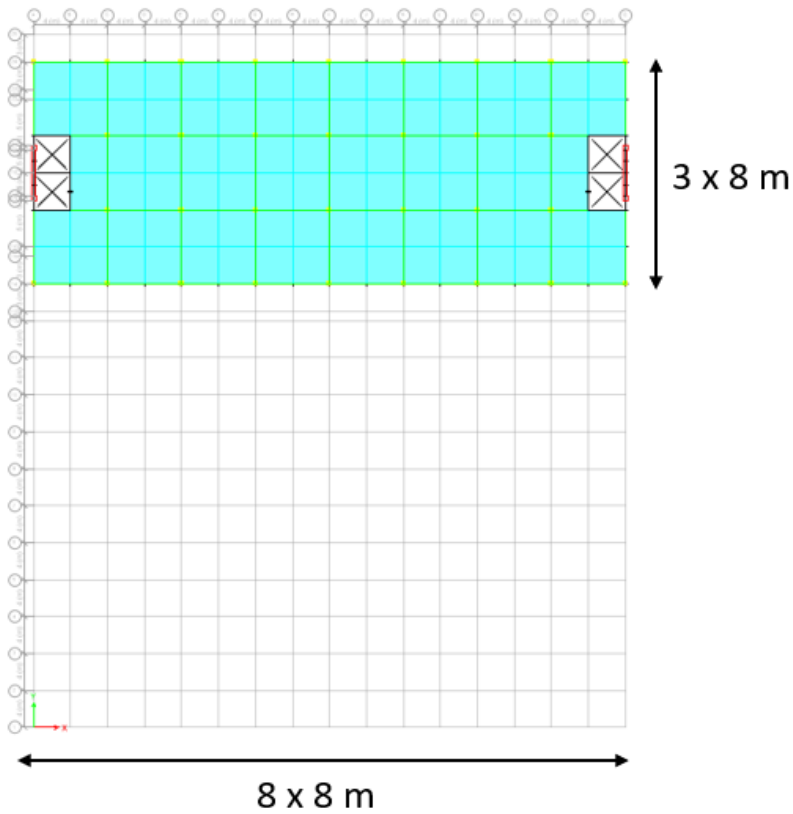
Denah Tipikal Lantai 8 dan 10 Untuk Model 3
